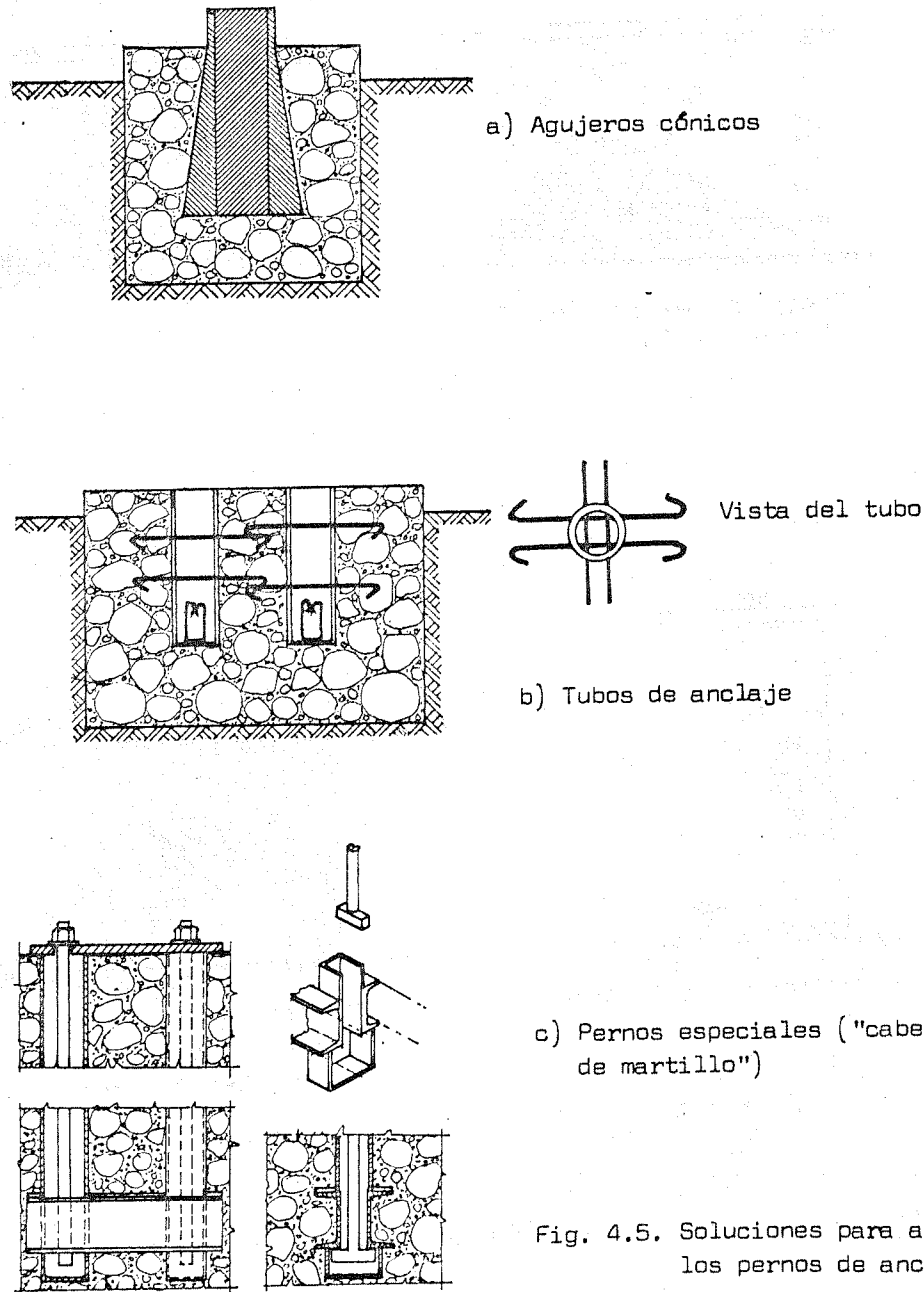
Soluciones para alojar los pernos de anclaje
